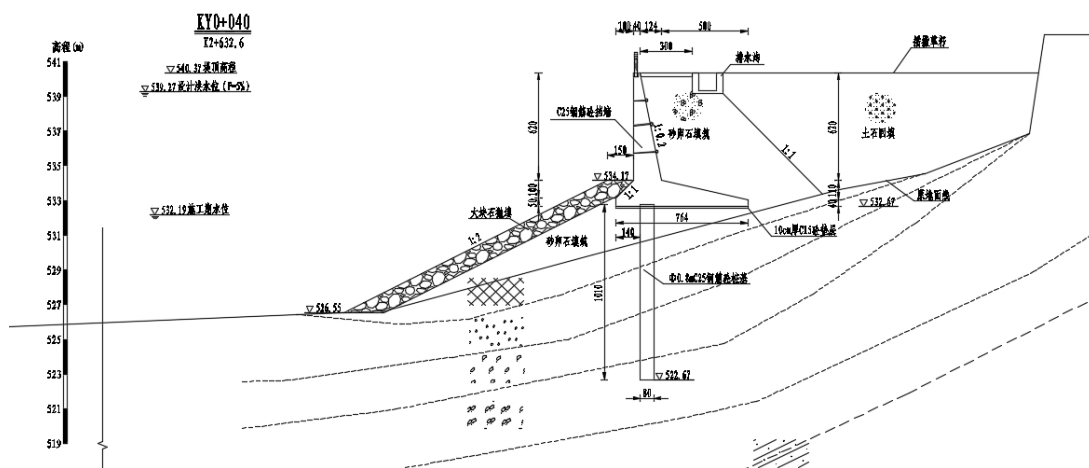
桩基础+C25 钢筋混凝土悬臂式挡墙
